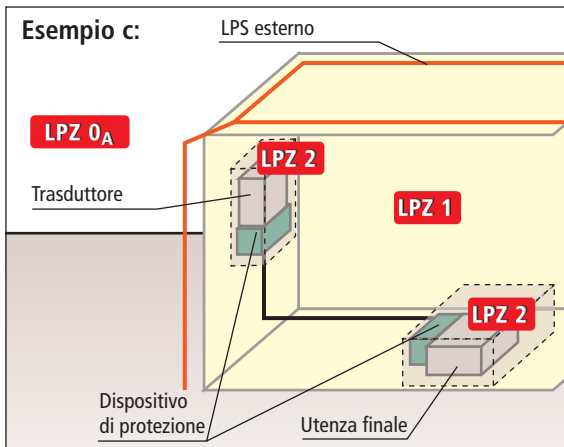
Edificio con LPS esterno e linee interne posate secondo il concetto di protezione da fulminazione a zone
